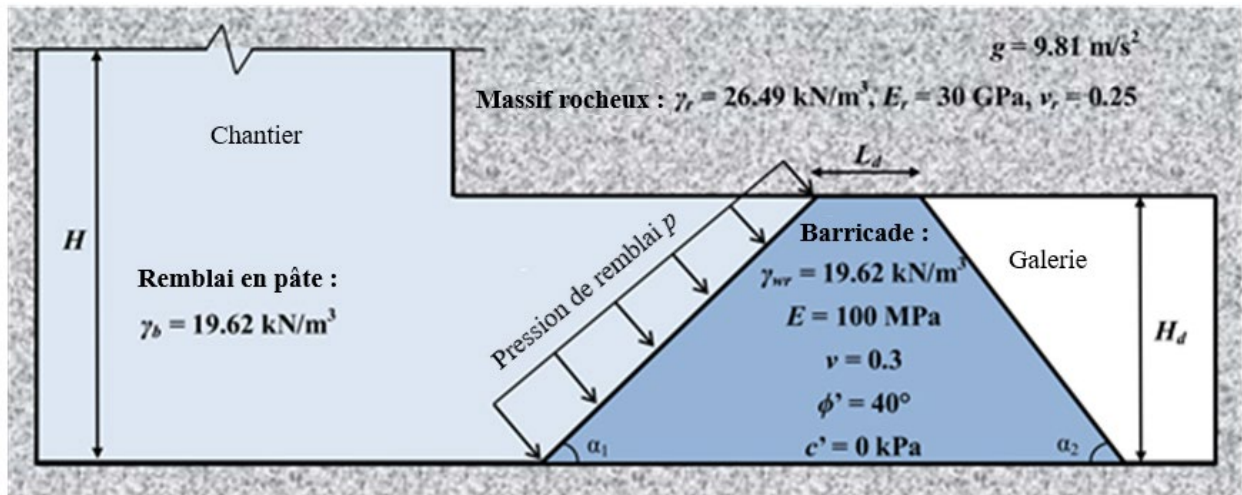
Une barricade construite en roches stériles pour retenir un remblai en pâte (tirée de Yang et al. 2017).
